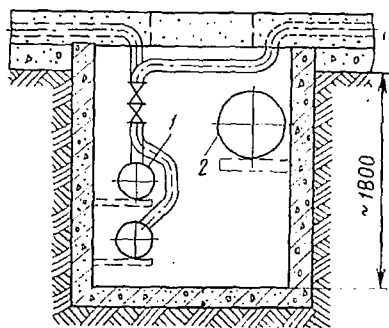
Совместная прокладка труб отопления и воздухопровода в подпольном канале:
